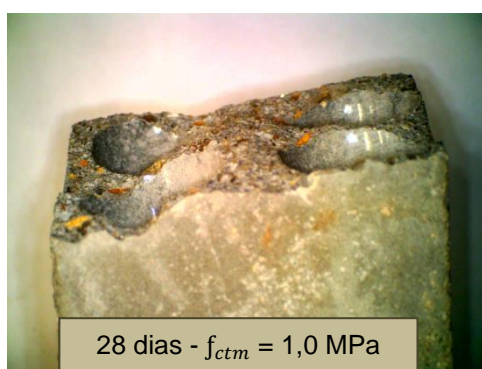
Superfície de fractura de provete com esferas de vidro ensaiado à tracção axial (Fractura através da ITZ, com destaque dos agregados)
